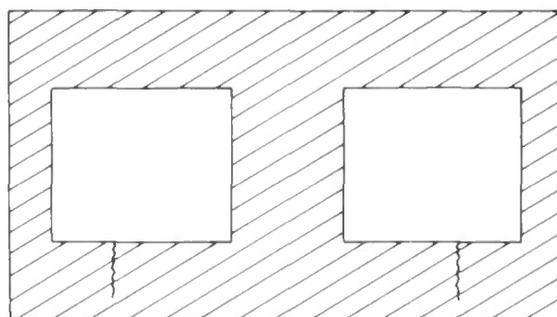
Fissuration longitudinale d'arcs en caisson.
